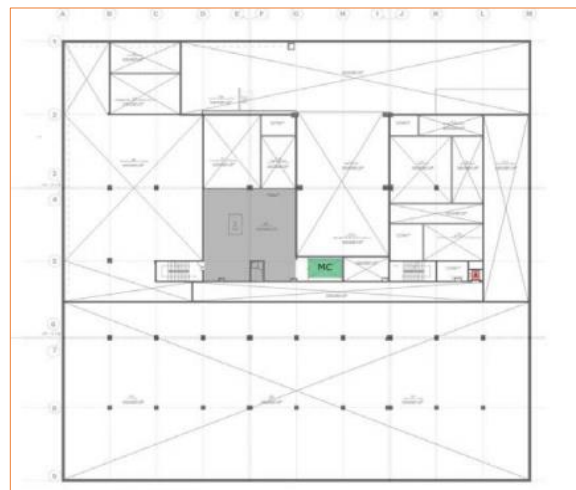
Plan R-1 de centre de conservation Marseille.
